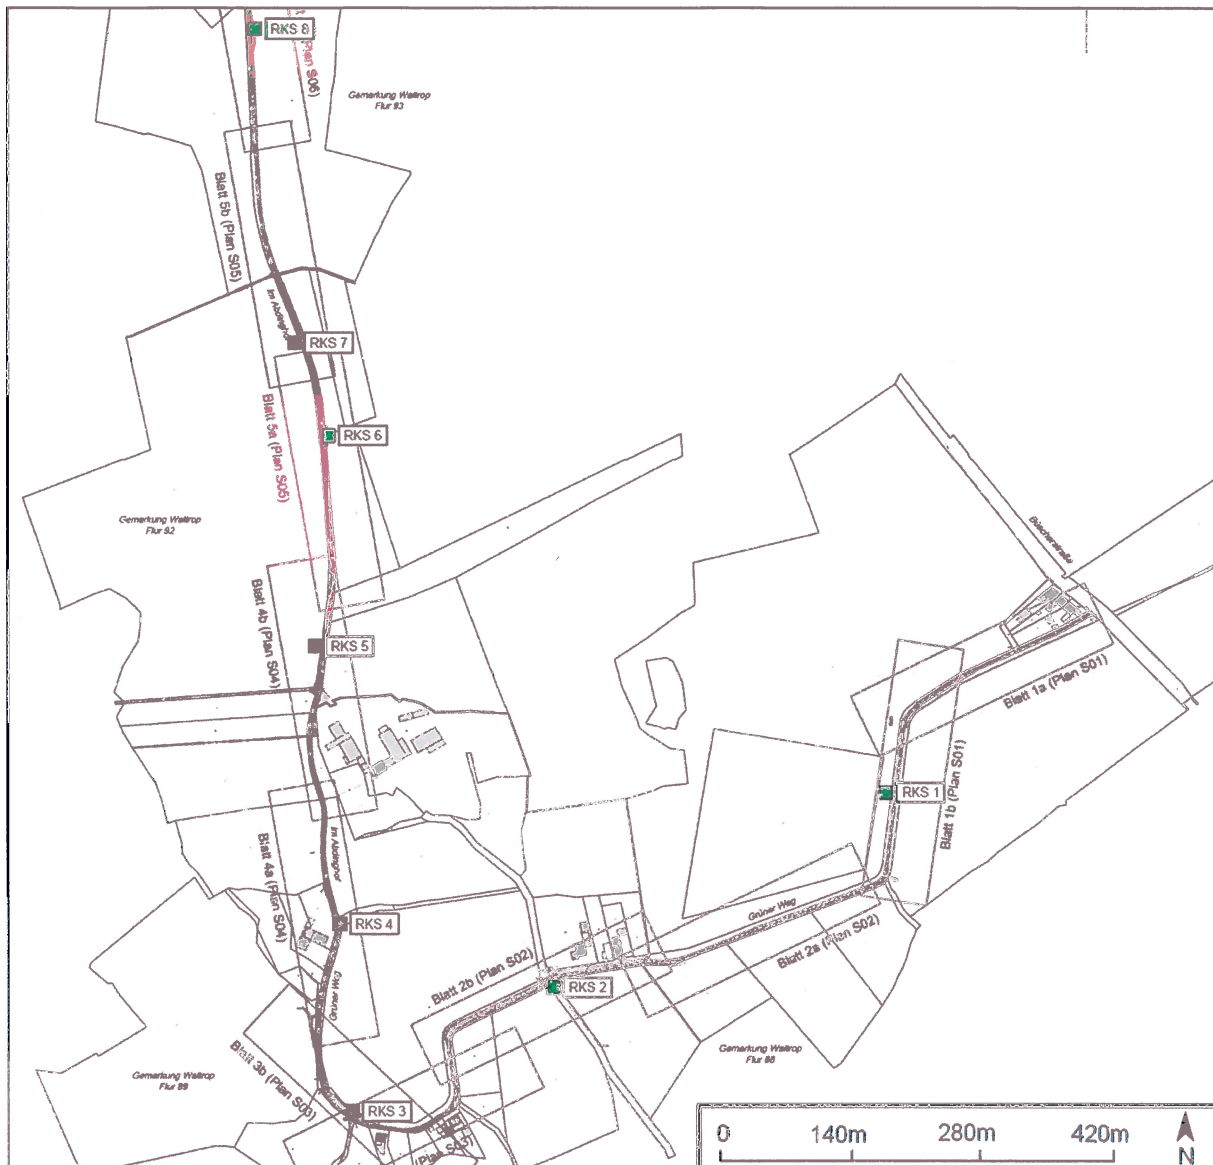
Lageplan der Untersuchungspunkte (Grundlage: Weber Ingenieure GmbH Vorplanung LP2 v. 14.01.26)
